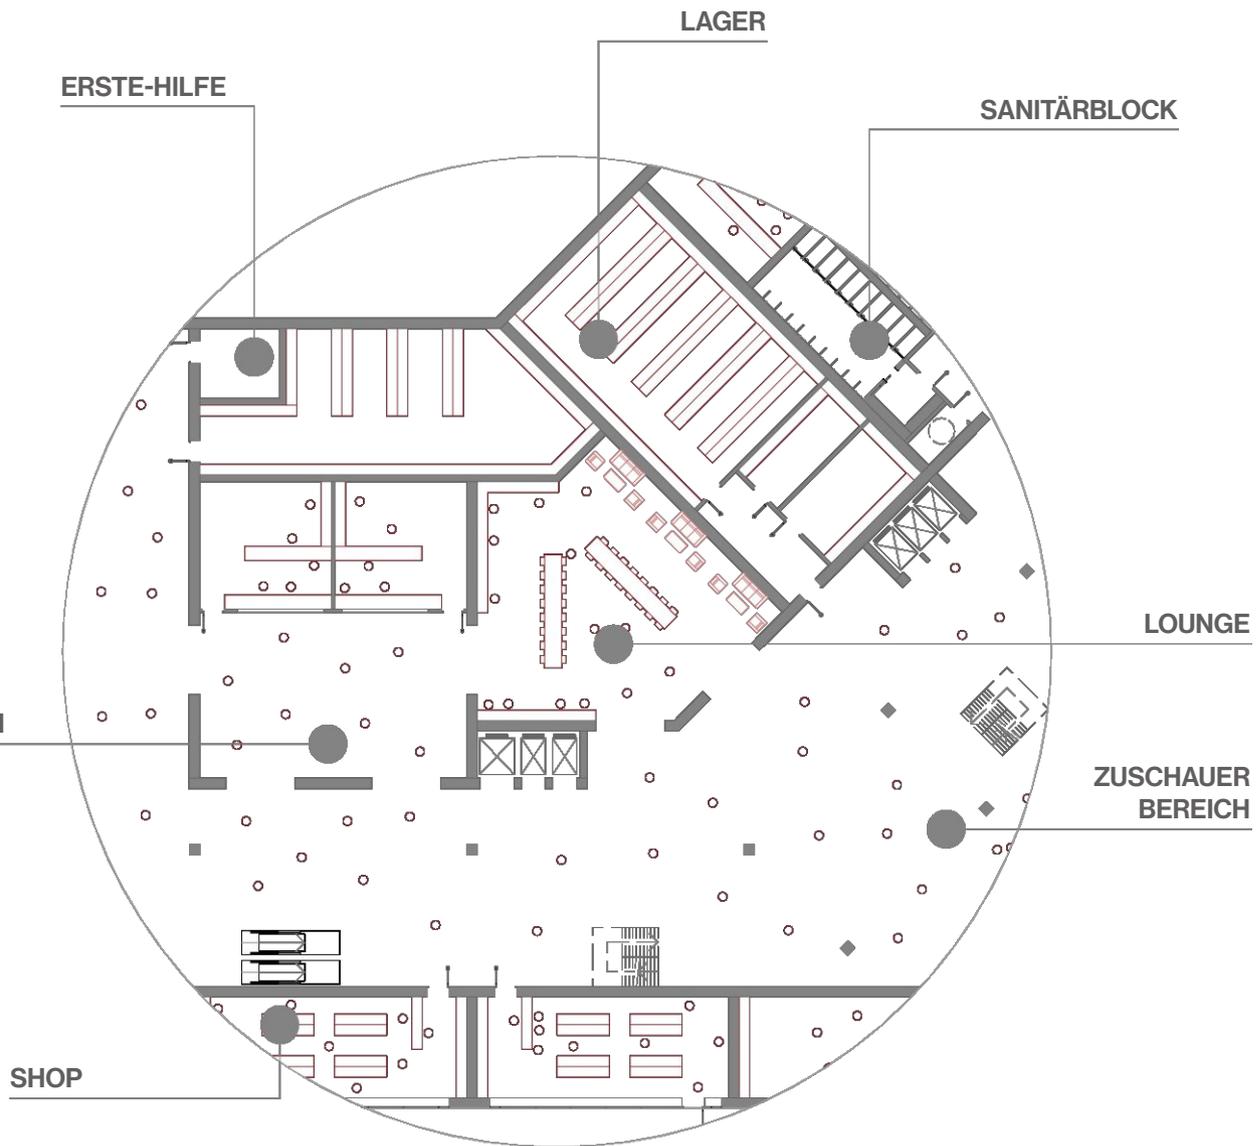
Grundriss EG Zoom Ostflügel 2
